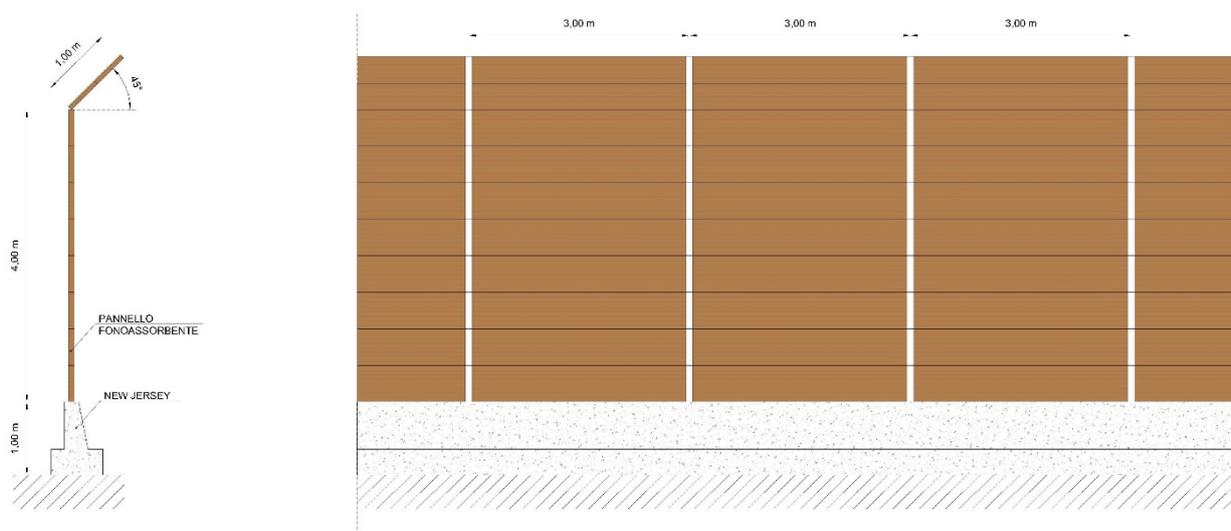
progetto sistemazione pannelli fonoassorbenti
